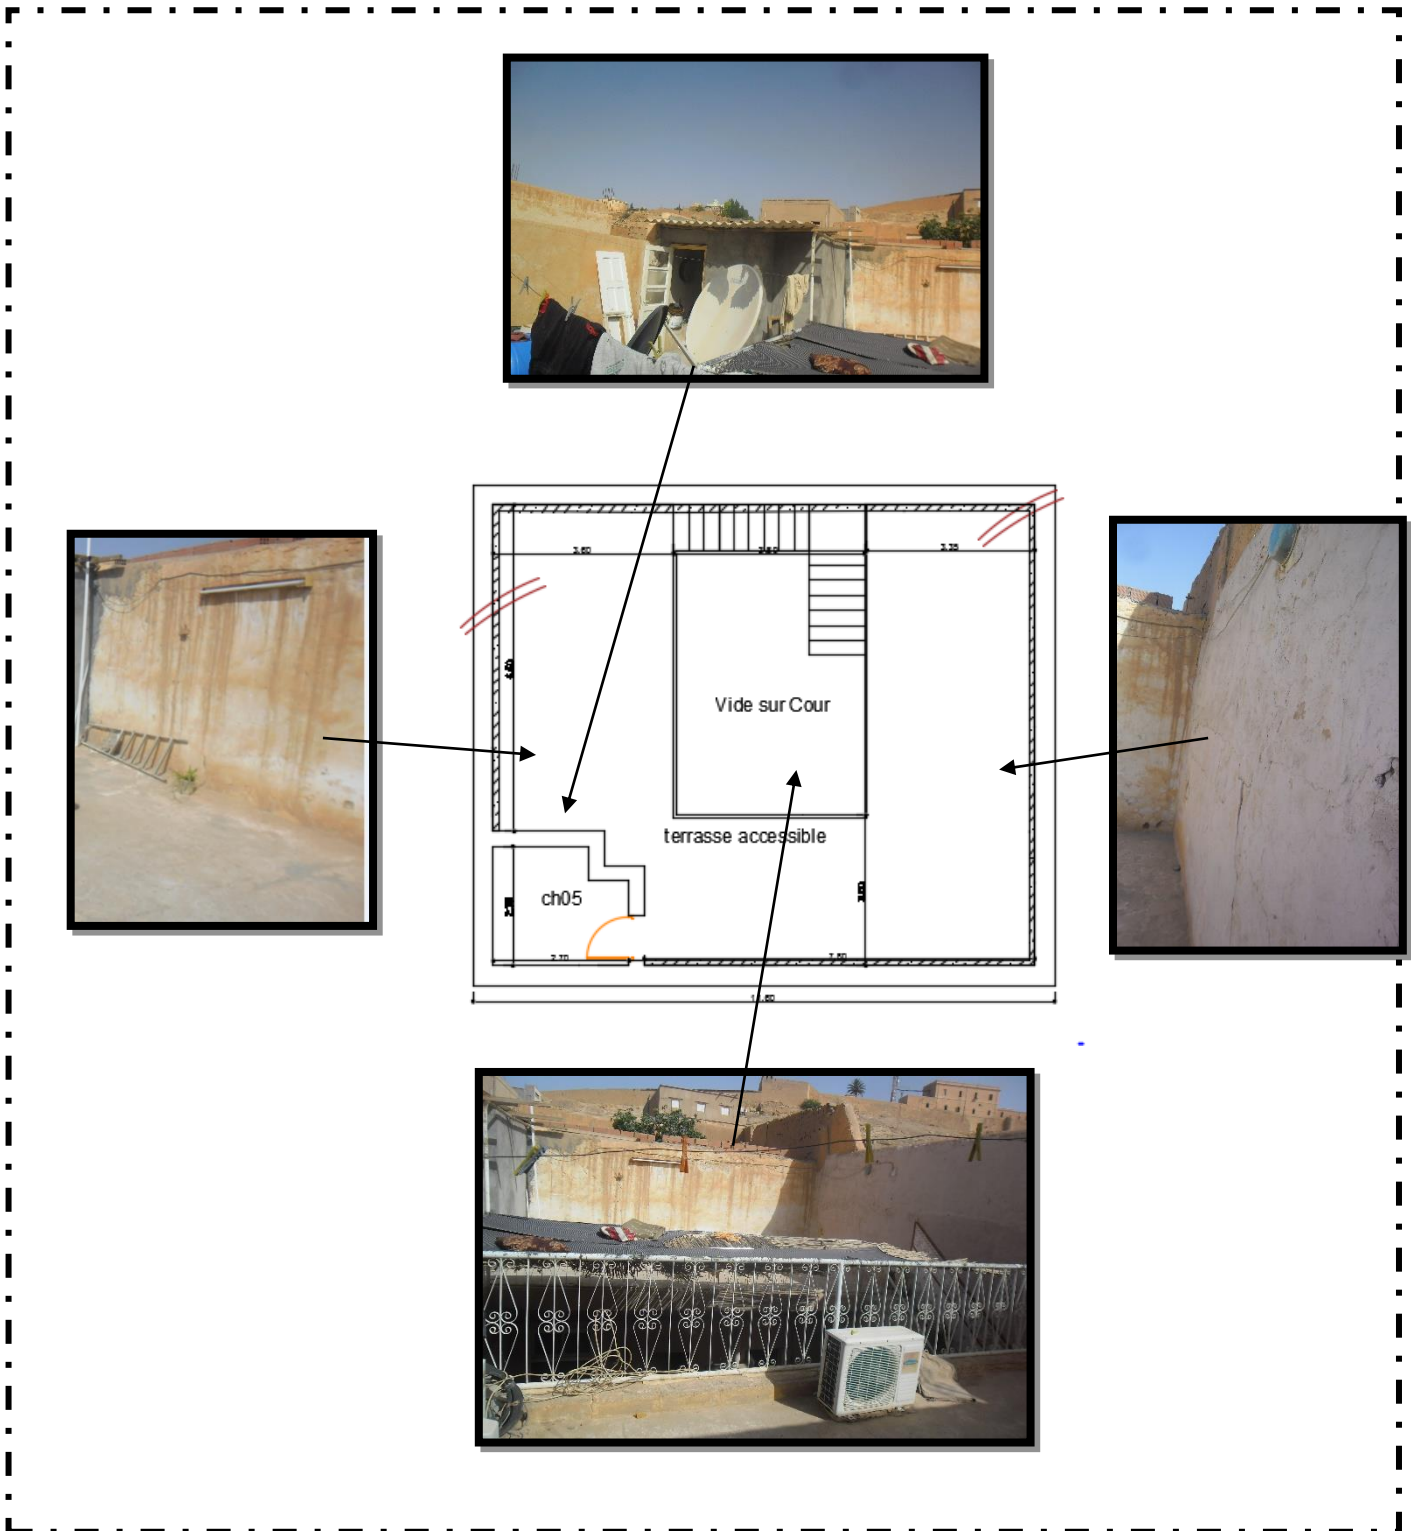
Plan état des lieux : terrasse accessible / Source : Etudiante
